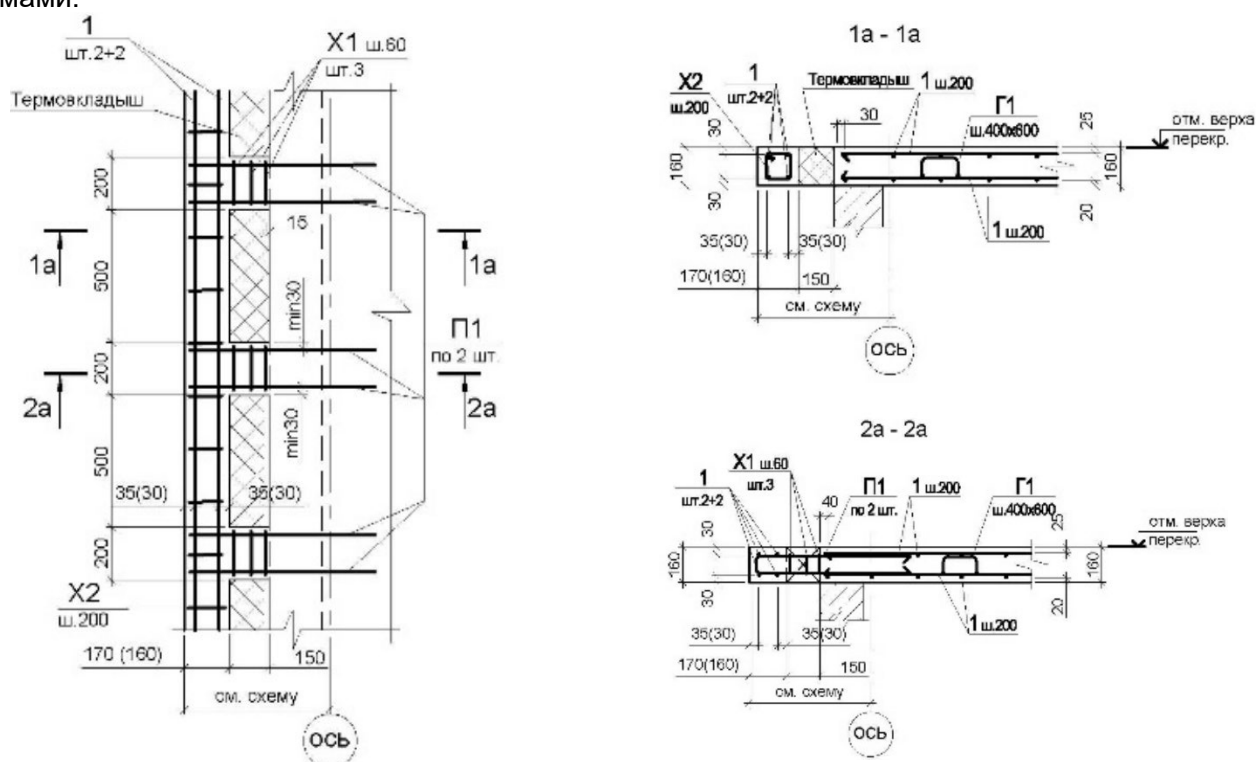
Схема армирования фрагмента плиты перекрытия в зоне устройства перфорации (схемы разработаны авторами)
